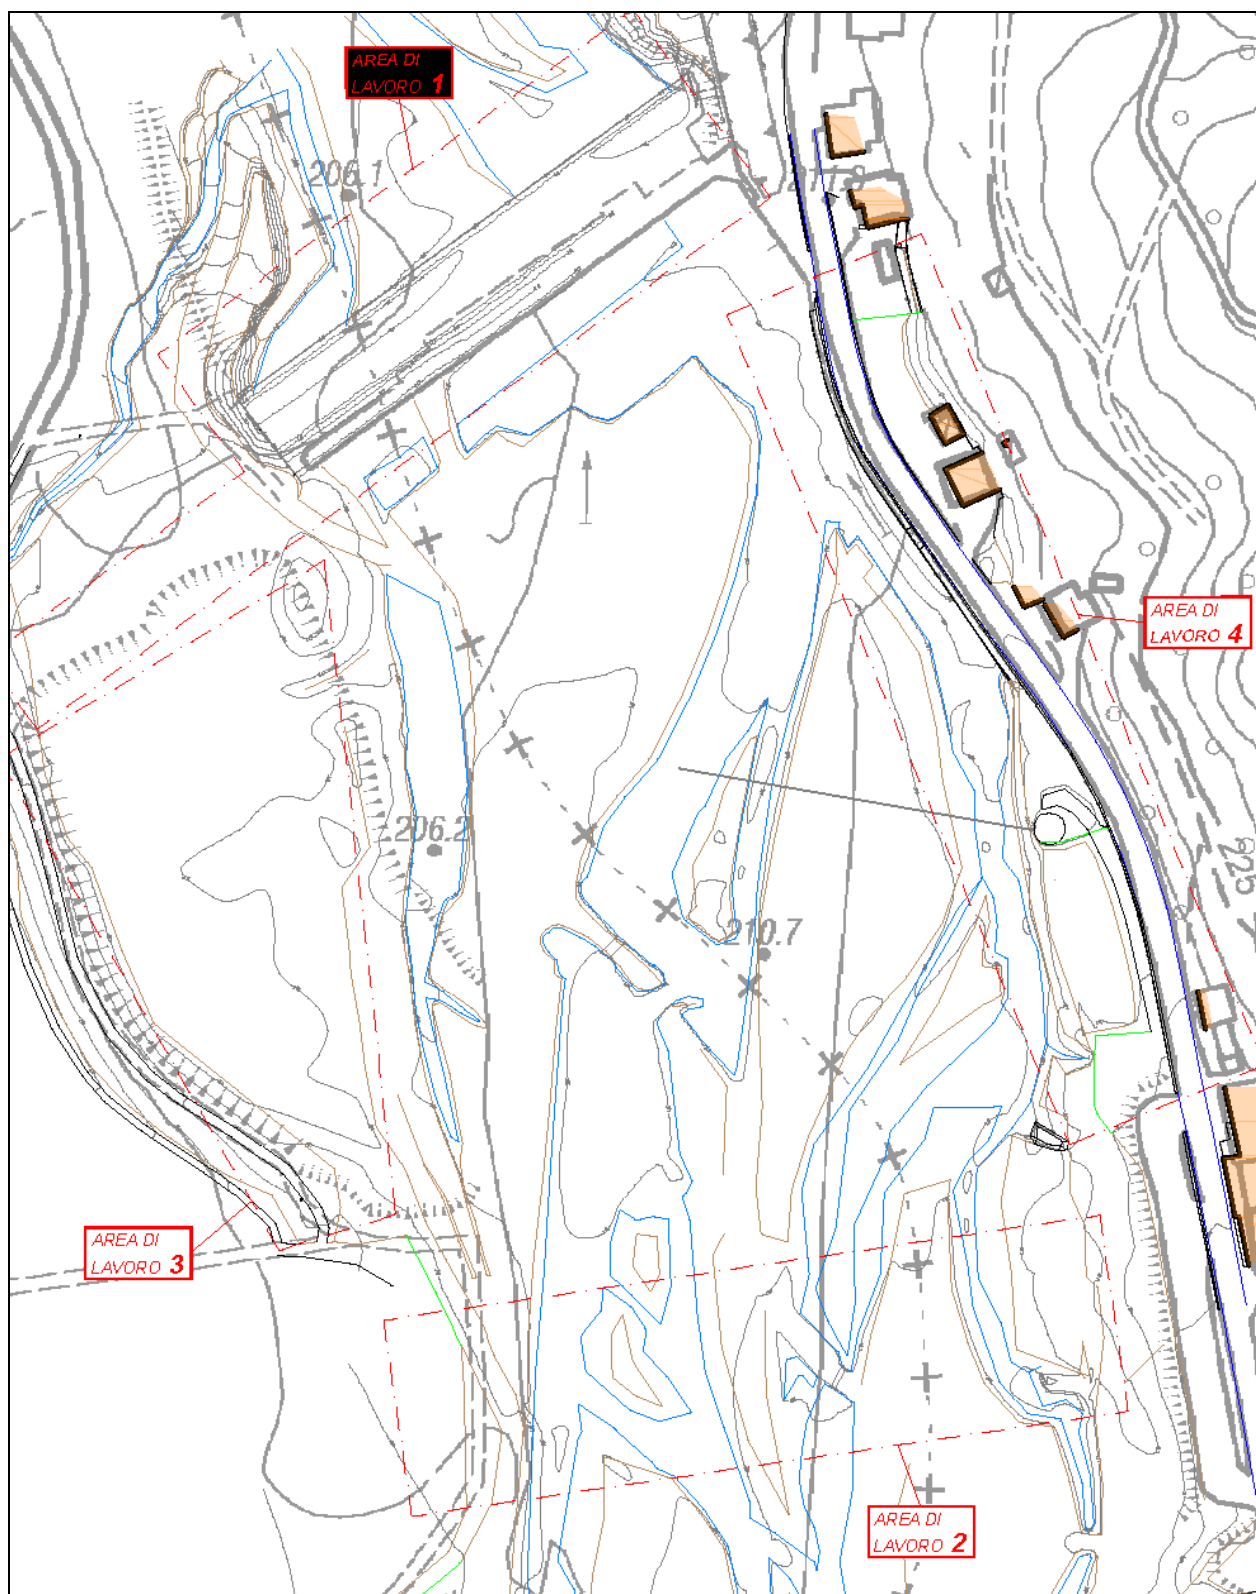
Planimetria con indicazione delle aree di lavoro
